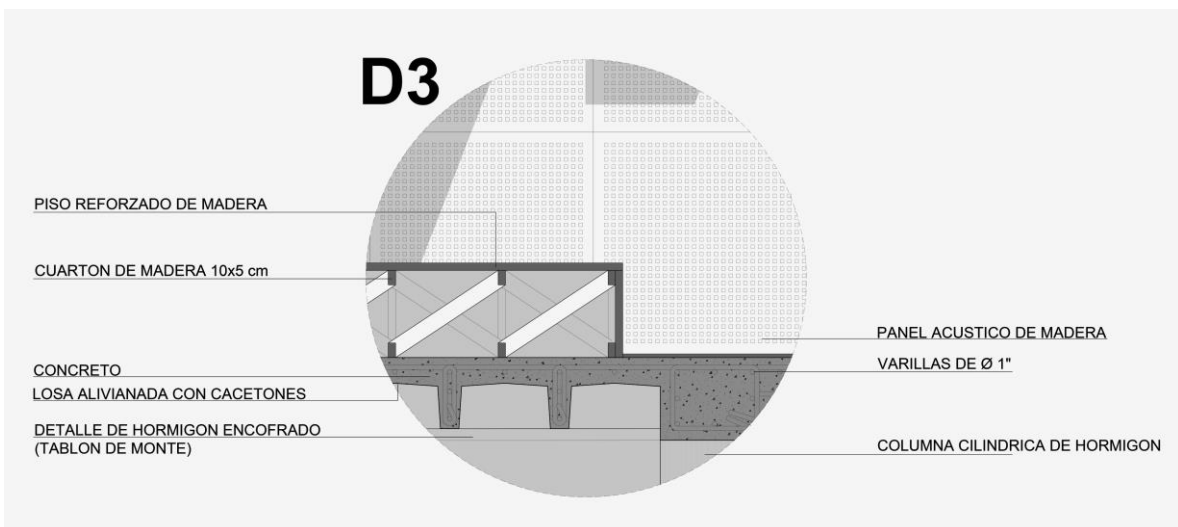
Detalle 3. Corte por fachada 2. Elaboración propia.
